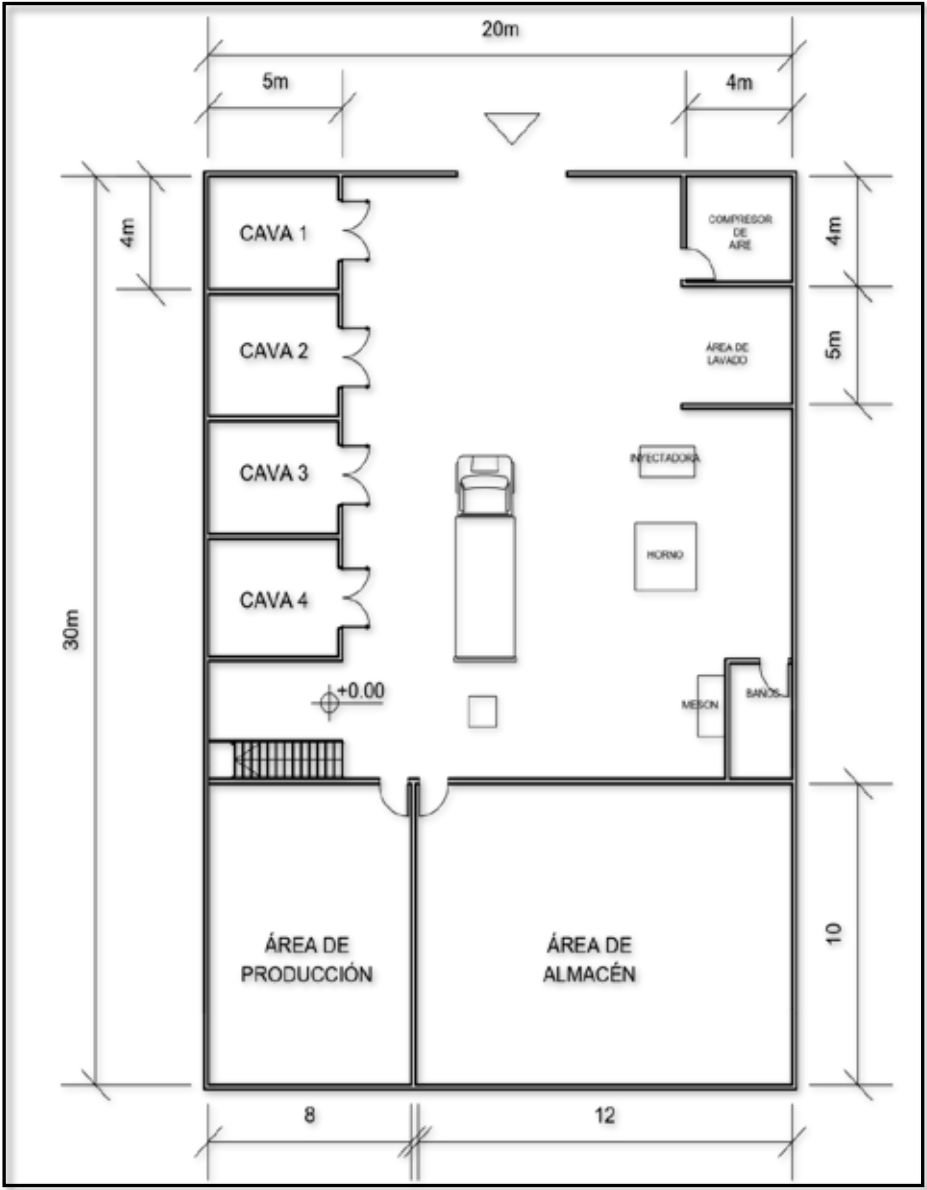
Distribución de planta. Planta de abajo. Fuente: Armas, D. (2018)
